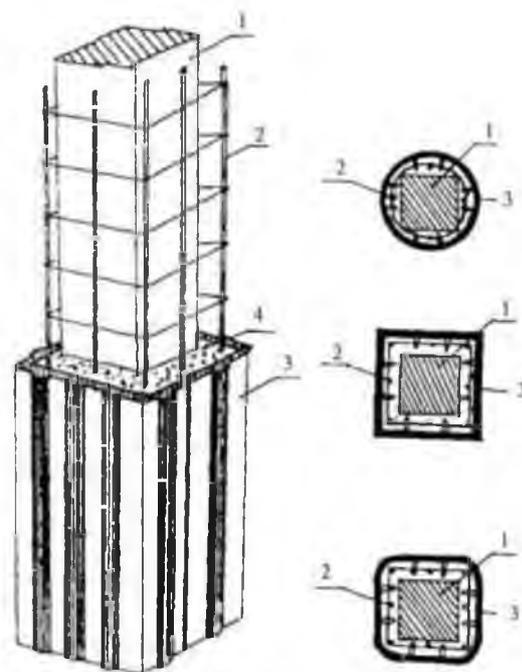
Посилення стовпів з використанням опалубки-облицювання з архітектурного бетону 1 – конструкція підсилення; 2 - армокаркас; 3 - елементи облицювання; 4 - бетон омонолічування
